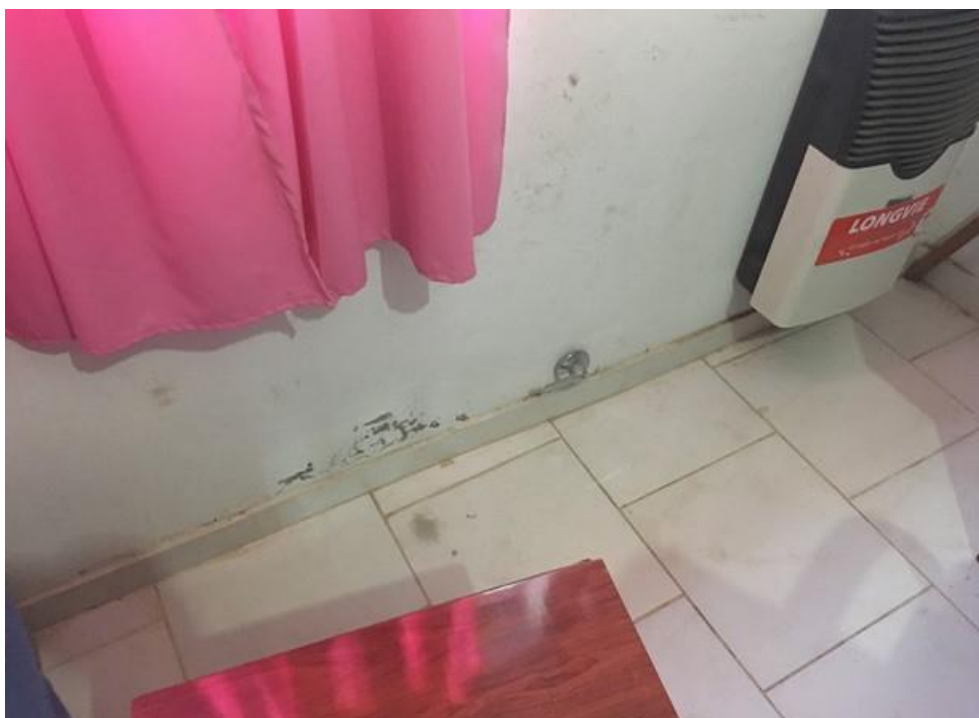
96 viviendas apareadas en Cipolletti – Terminaciones (Plan 2552)
